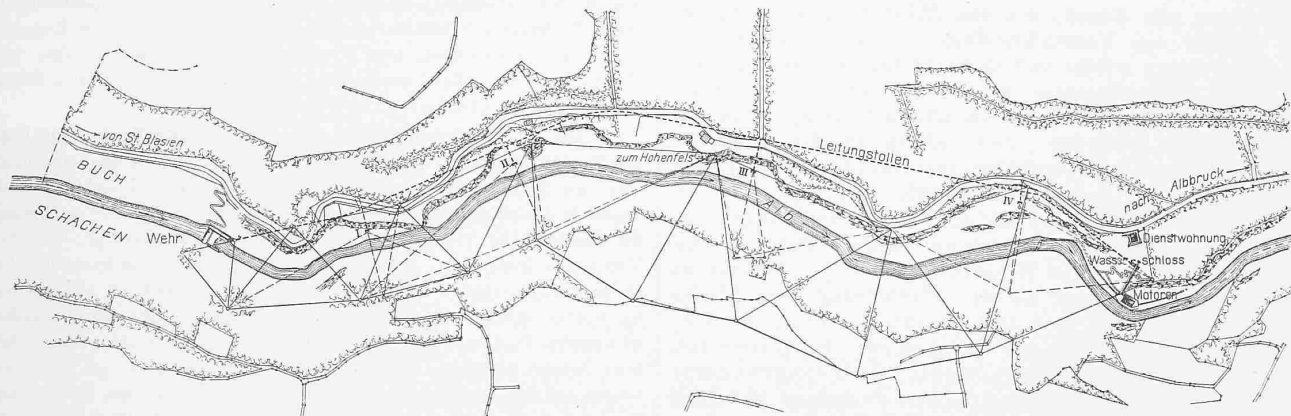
Lageplan mit der Triangulation für den Leitungstollen. — Masstab 1:10000.
